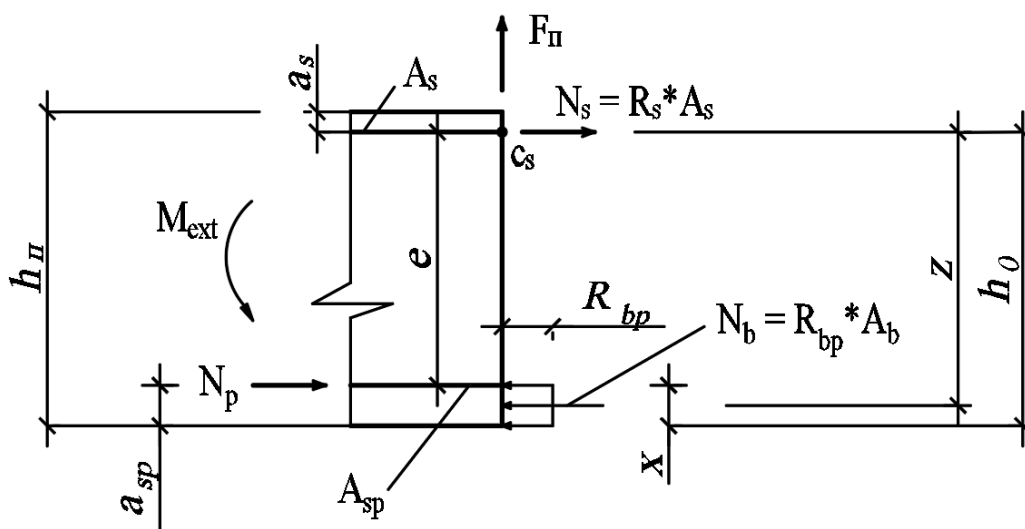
Схема внешних и внутренних усилий в расчетном сечении
